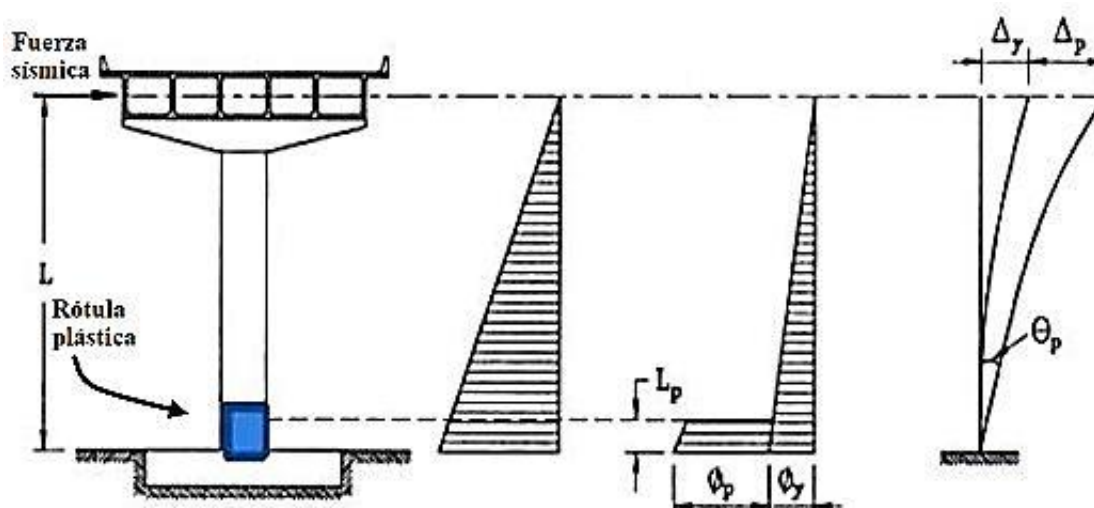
Zona de rotula plástica en la columna y/o pila del puente
